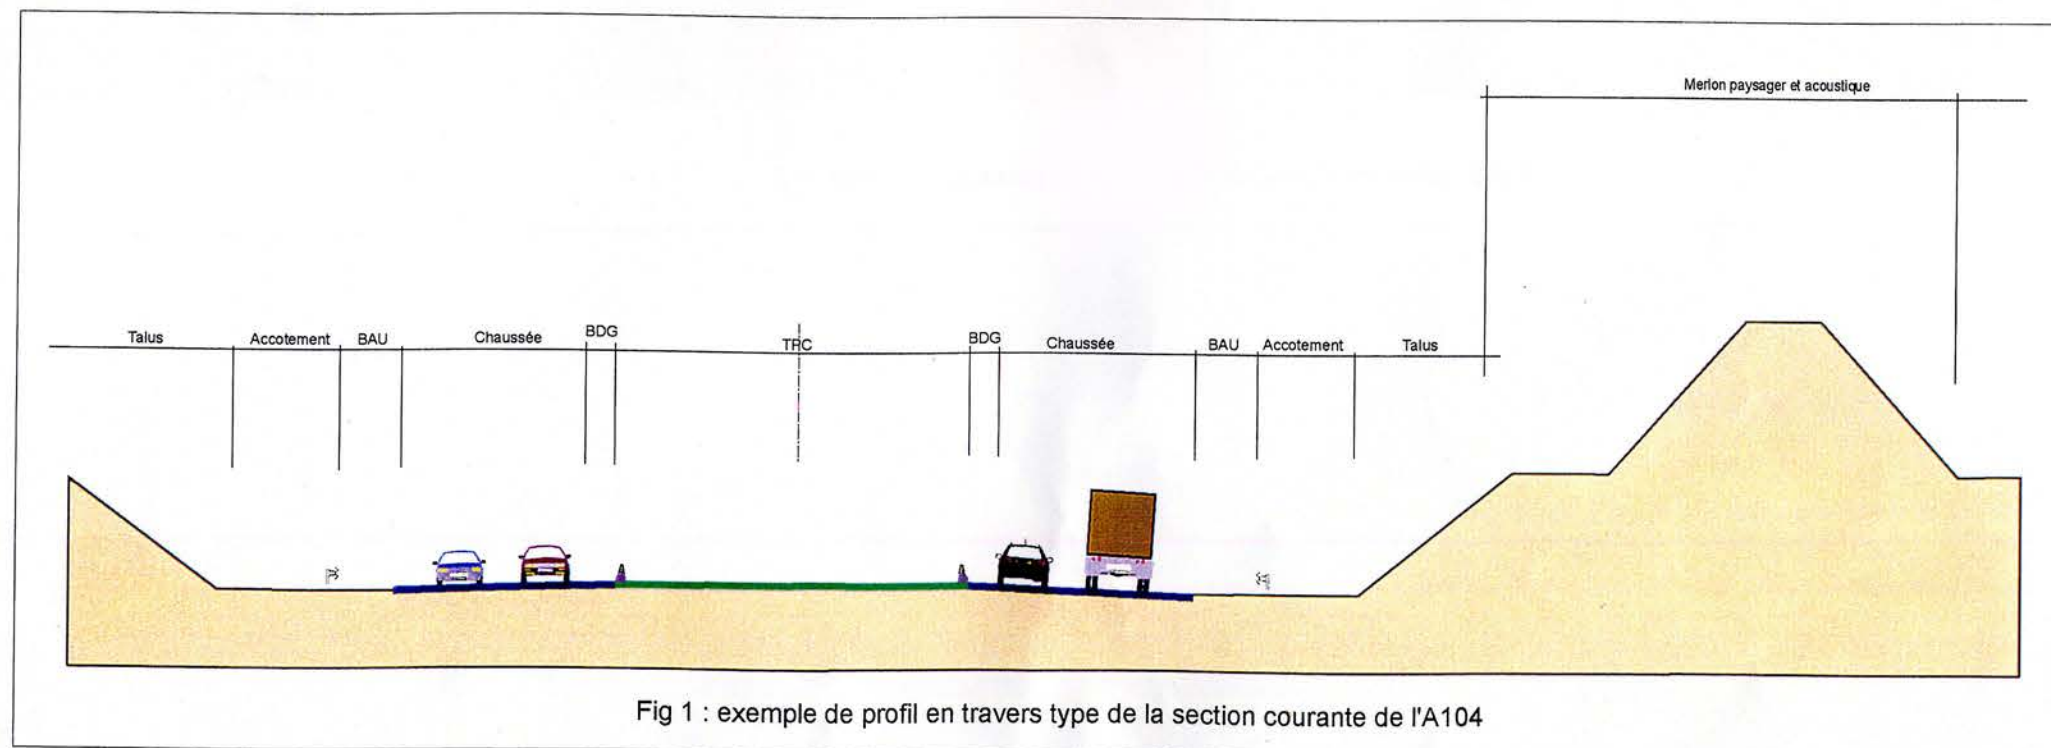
exemple de profil en travers type de la section courante de l'A104
